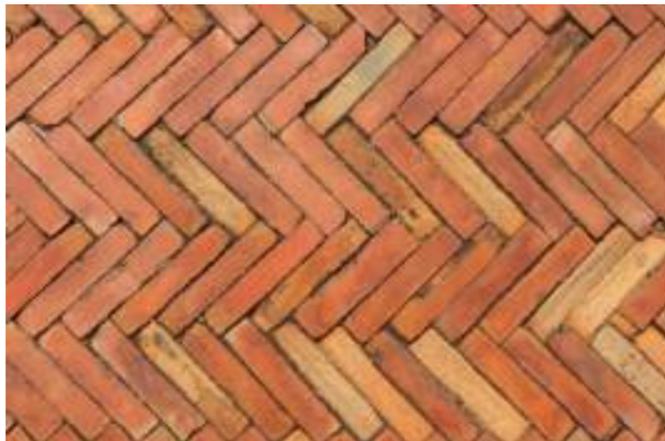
RÉEMPLOI DE BRIQUE PLEINE EN DALLAGE PIÉTONNIER (SOURCE : WIENERBERGER)
